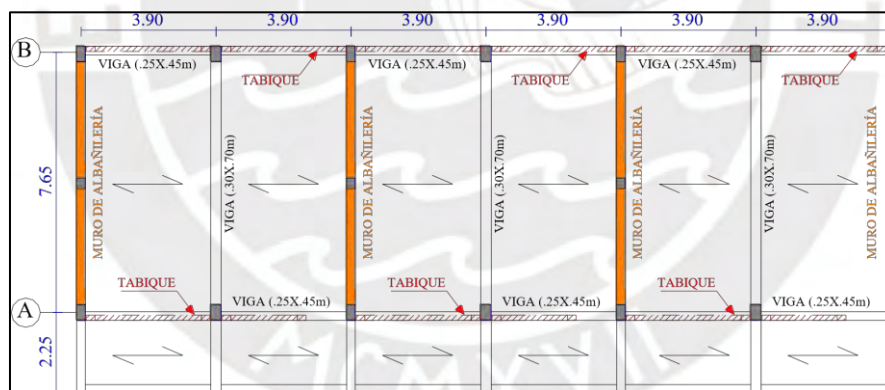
Planta de colegio 780 PRE (Fuente: Loa, 2017)
